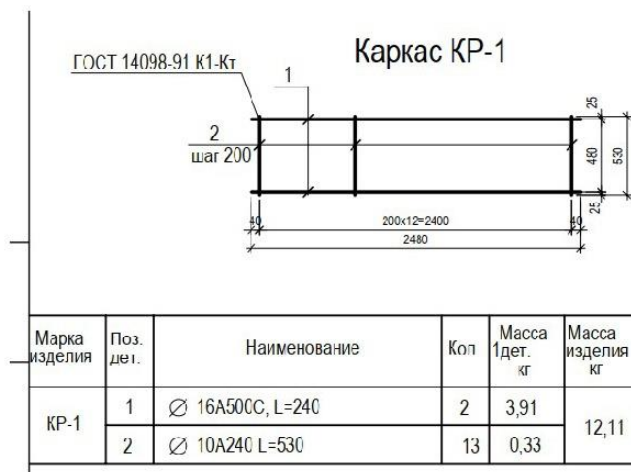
Армирование фундаментов контрфорсов предусмотрено двумя каркасами с продольной арматурой диаметром 16 мм, причем не предусмотрено соединение продольных стержней непосредственно с арматурой ростверка
